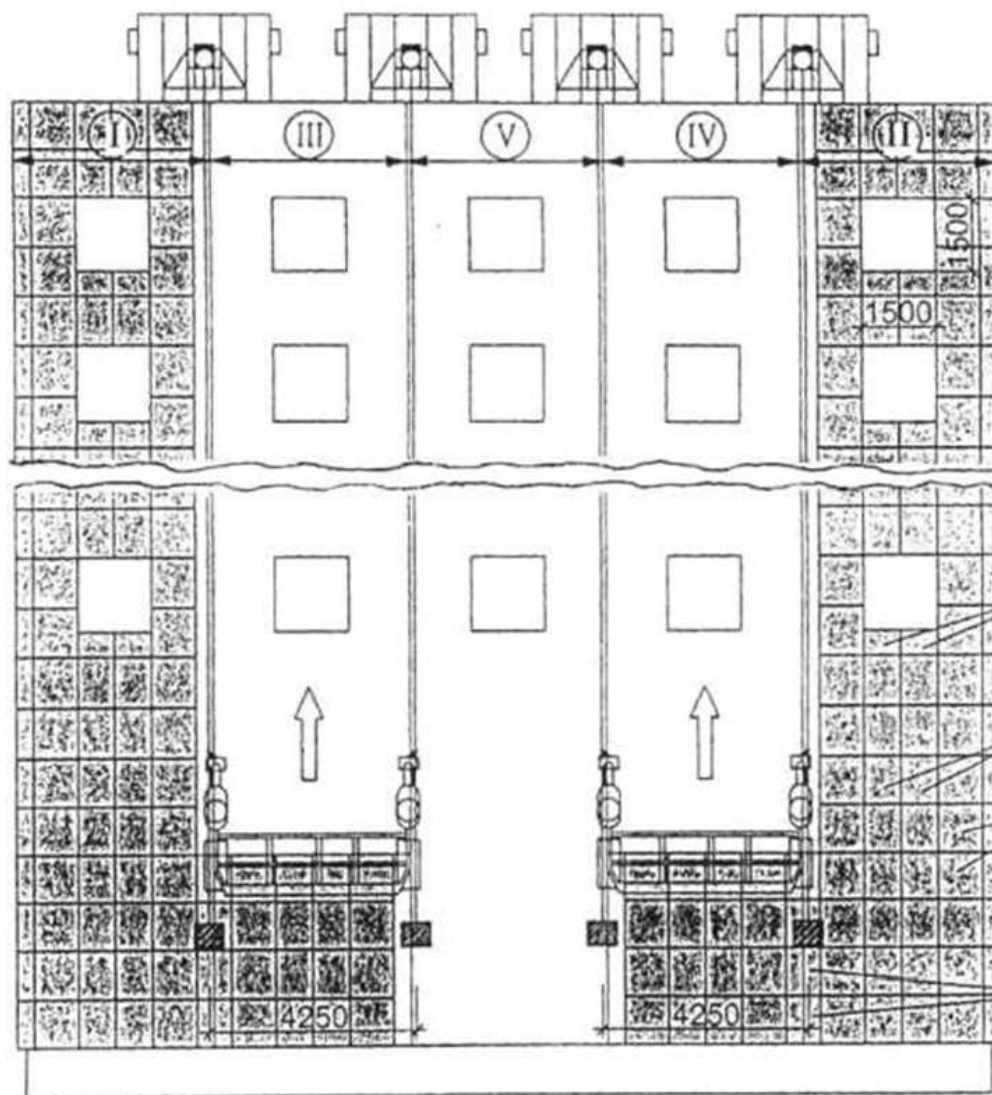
Схема утепления фасад здания, где I, II, III, IV – номера захваток
